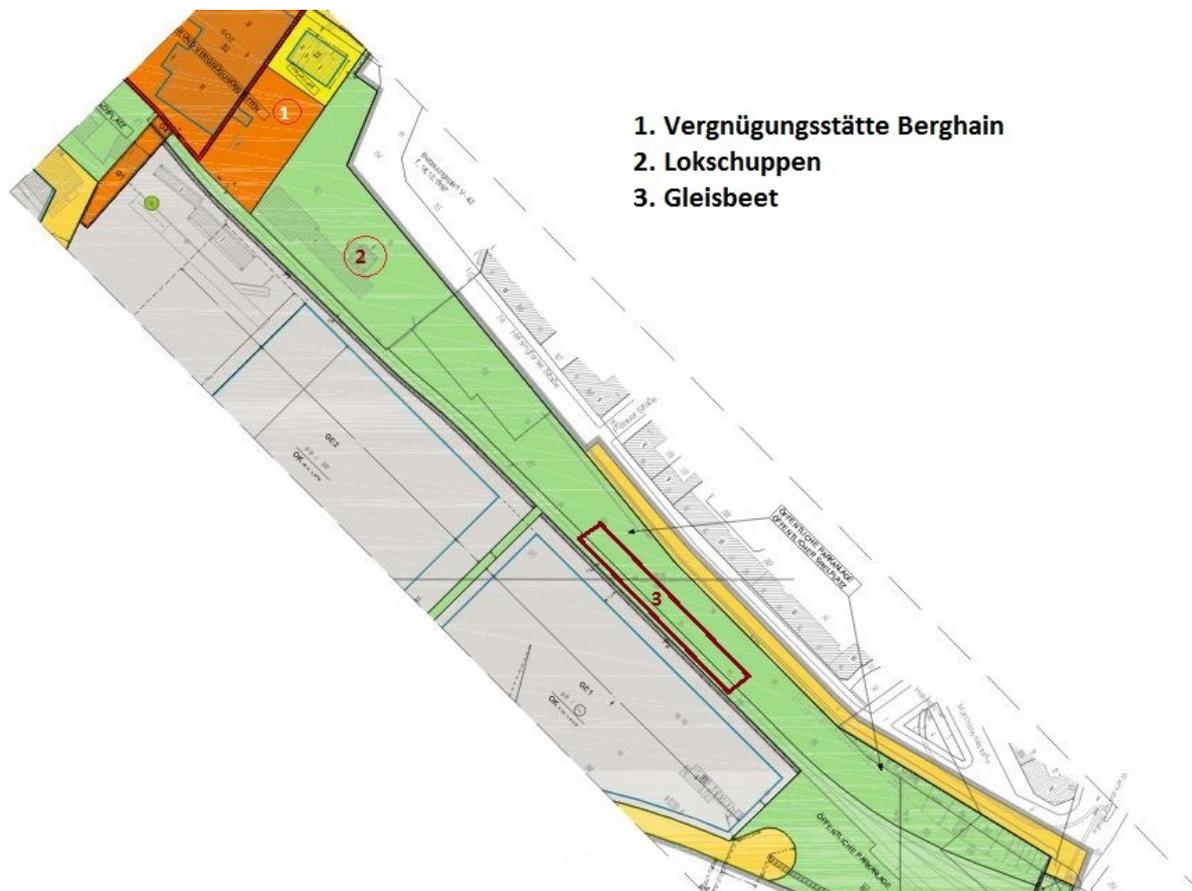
Lageplan des nutzbaren Wriezener Parks
